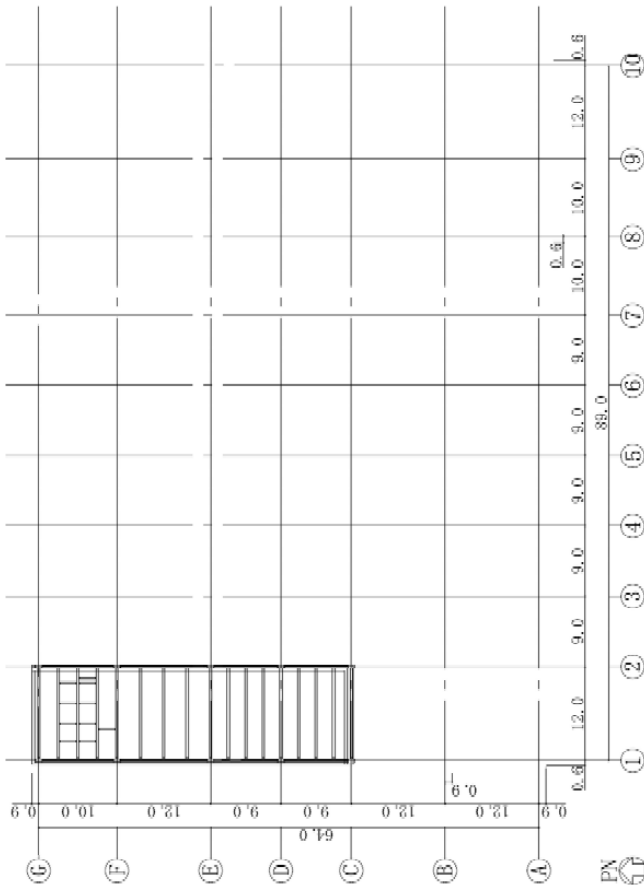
屋上階平面図 (G.L.+10.3) (単位 : m)
